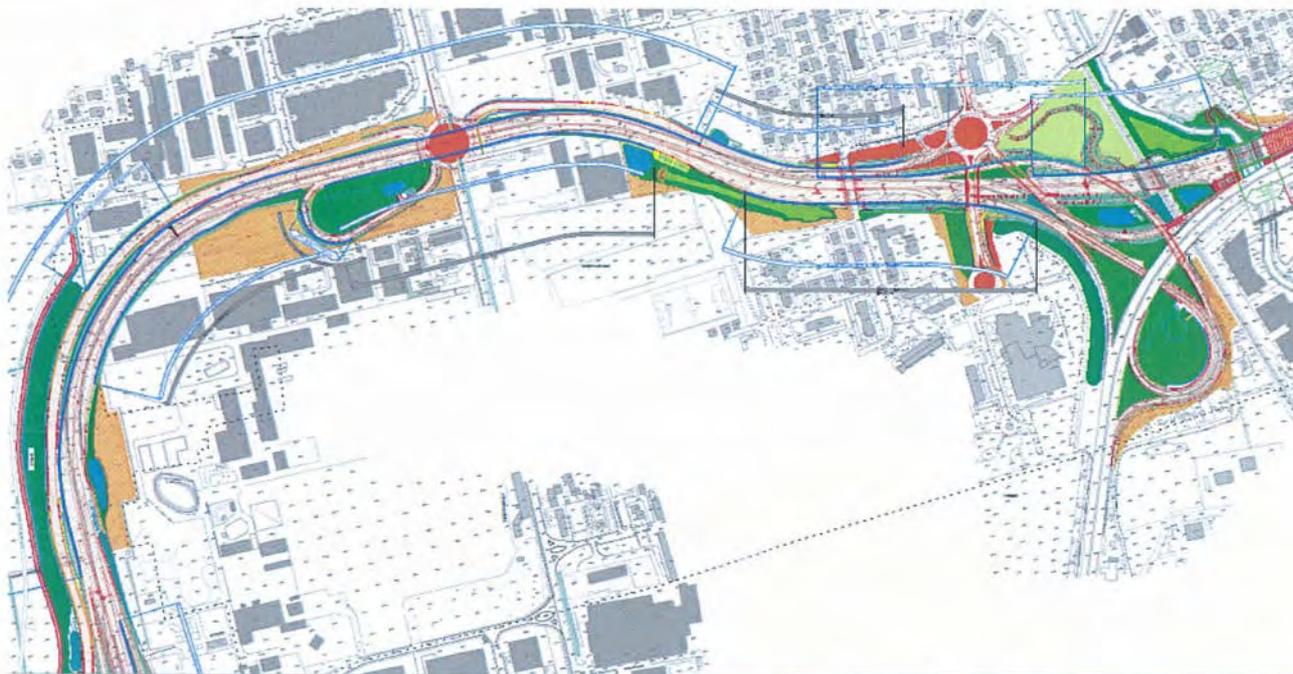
Progetto di riqualificazione della SP 46: assetto infrastrutturale di riferimento
